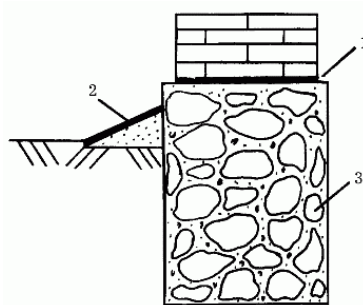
Бутобетонный ленточный фундамент: 1 – горизонтальная гидроизоляция; 2 – отмостка; 3 – бутовый камень
